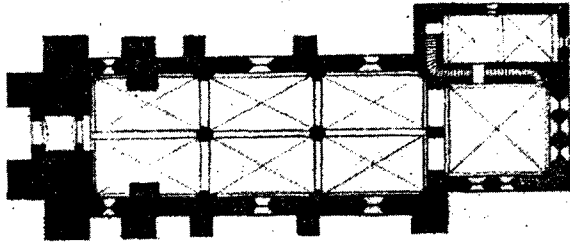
Grundriss der Kirche zu Kaarma. Nach
